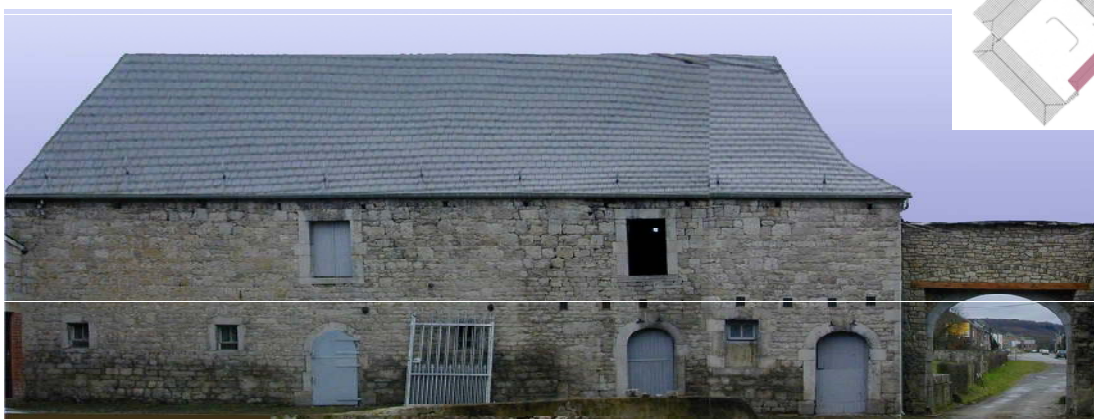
Elévation de la façade sur cour du corps d'étable Ouest. Photo redressée IG 2003.
